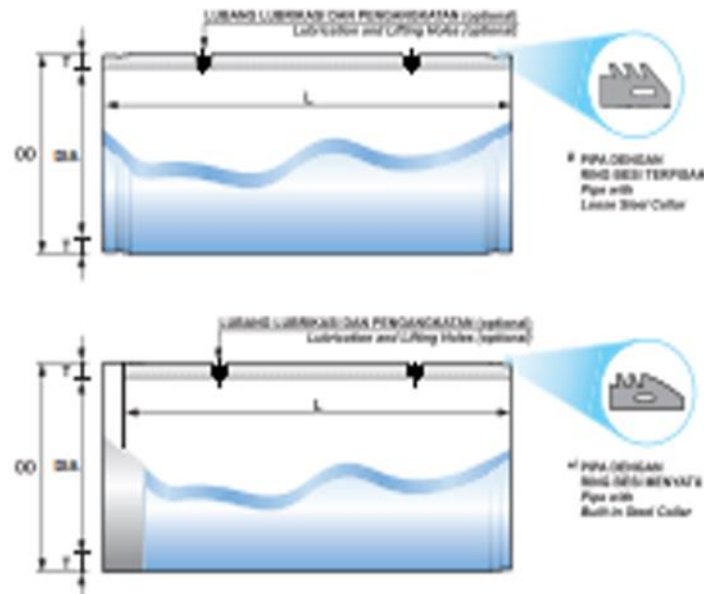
jenis pipa RCCP Sumber : Foto dari PT Bonna Produk Pipa Jacking bentuk RCCP (Reinforce Concrete Circullar Pipe)
